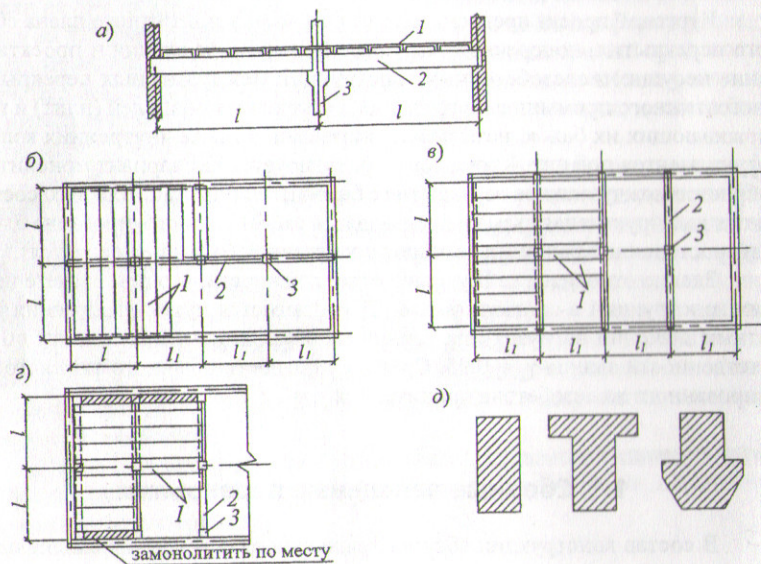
Конструктивные схемы сборных балочных панельных перекрытий:
